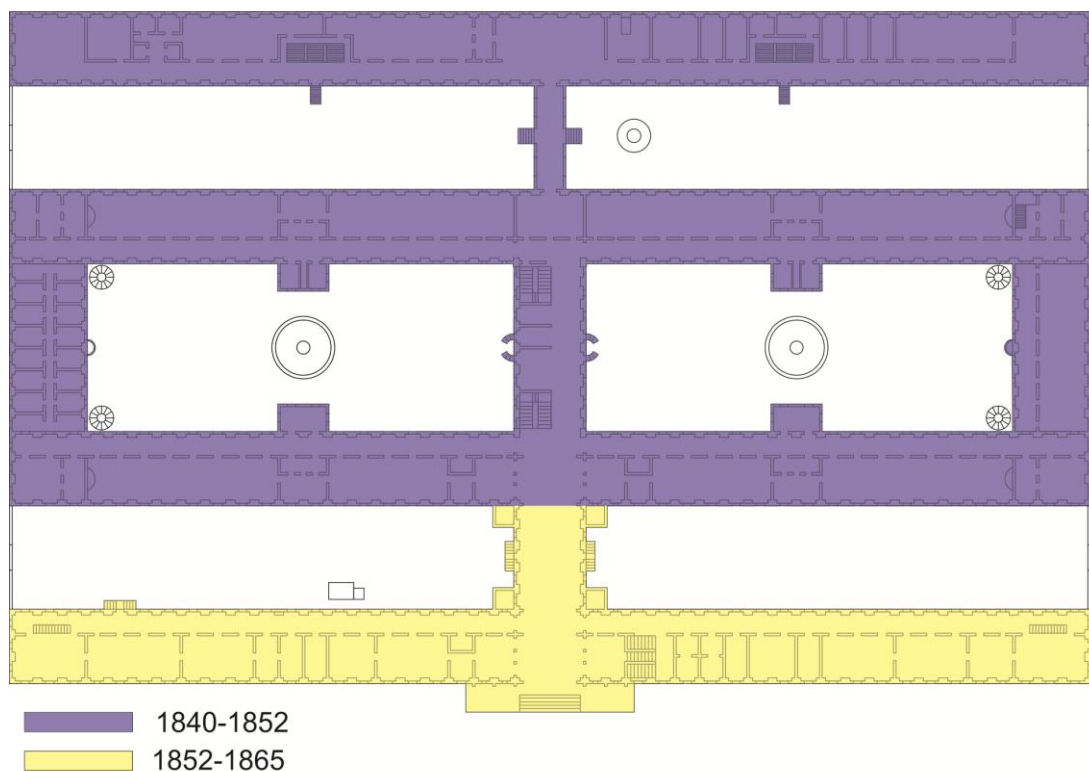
Planta da Santa Casa da Misericórdia representando a data de construção de cada bloco de seu conjunto arquitetônico. Fonte: Arquivo Central do IPHAN/RJ, 1938, adaptado pela Autora, 2014 [Desenho de Fernanda Trindade].
